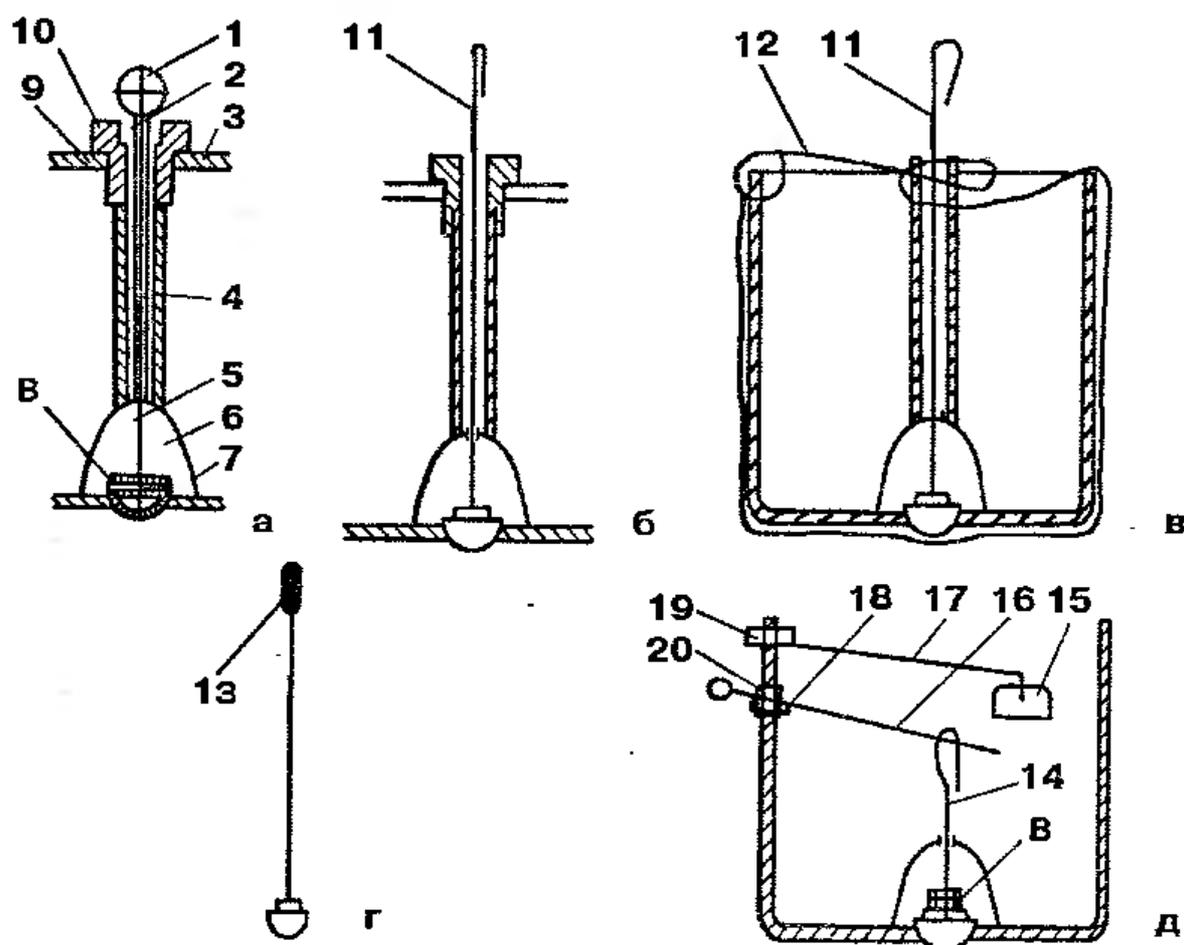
Спускные механизмы смывных бачков: а — верхний спускной стандартный механизм; б — верхний спускной дозирующий механизм при стандартной или самодельной крышке смывного бачка; в — верхний спускной дозирующий механизм при отсутствии крышки; г — удлиненная тяга с самодельной отделяемой рукояткой для верхнего спускного механизма; д — боковой спускной дозирующий механизм; 1 — рукоятка; 2 — тянущая трубка; 3 — крышка бачка; 4 — направляющая трубка; 5 — короткая тяга; 6 — груша; 7 — дуга; 8 — груз; 9 — прокладка; 10 — специальная втулка; 11 — удлиненная тяга; 12 — проволока; 13 — самодельная рукоятка; 14 — тяга с загибом; 15 — поплавок; 16 — спускной рычаг; 17 — рычаг поплавочного клапана; 18 — винты; 19 — поплавковый клапан в сборе; 20 — пластины крепления
